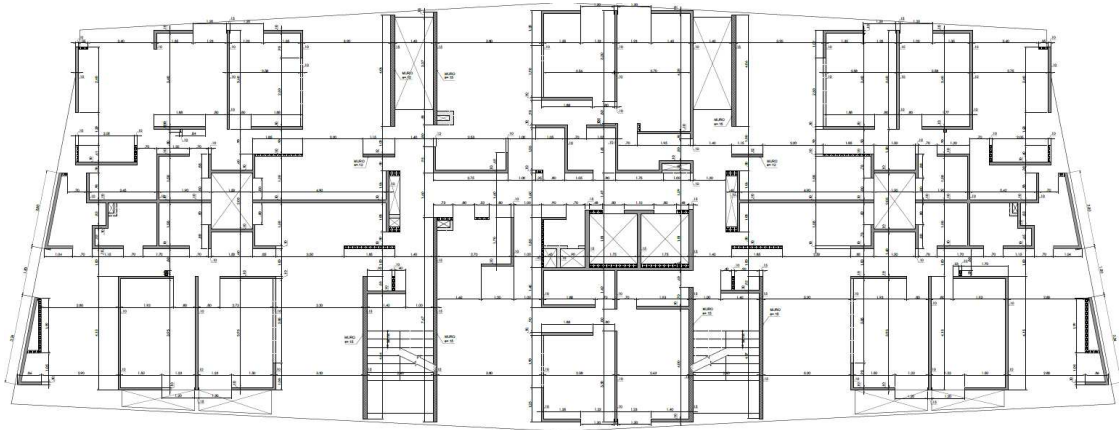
Planta Estructural Piso 17, muros $e=.10$ m. Fuente: Elaboración propia.
